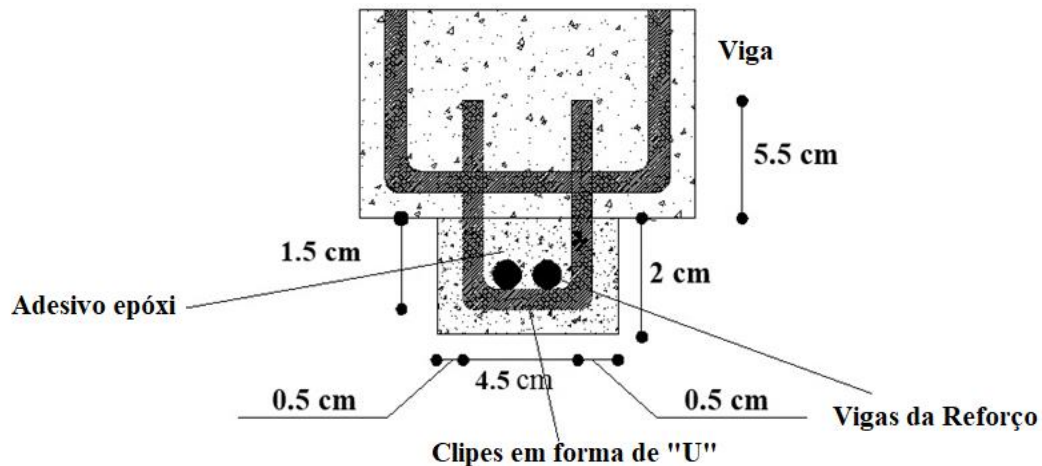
Detalhamento do grampo inserido nas vigas E3 e E5 para auxiliar na ancoragem entre o reforço e a peça.
